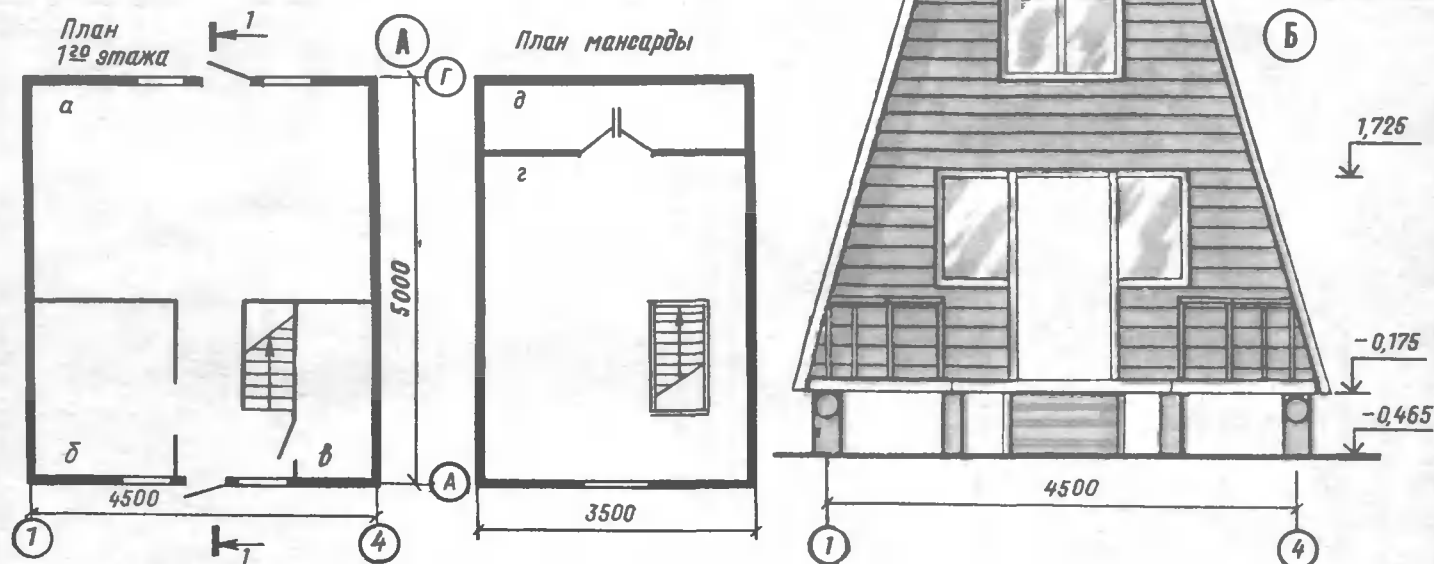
Садовый домик (А — планировка, Б — фасад 1—4):
